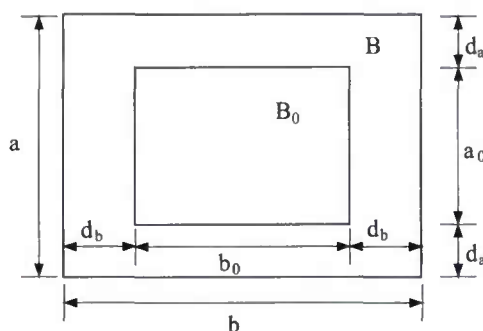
Dimensions en plan d'une cale et de son bossage
